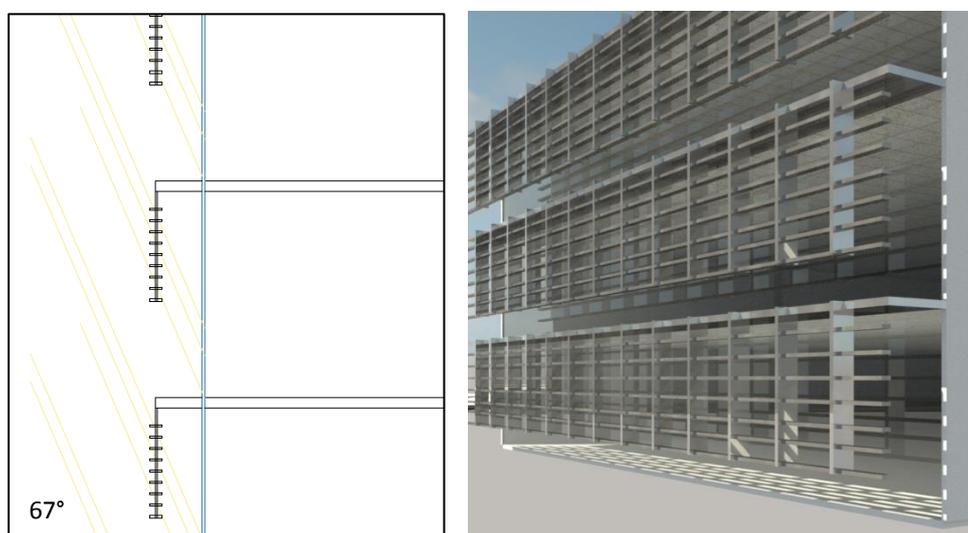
Propuesta protección Solar Edificio Lima Central Tower.
